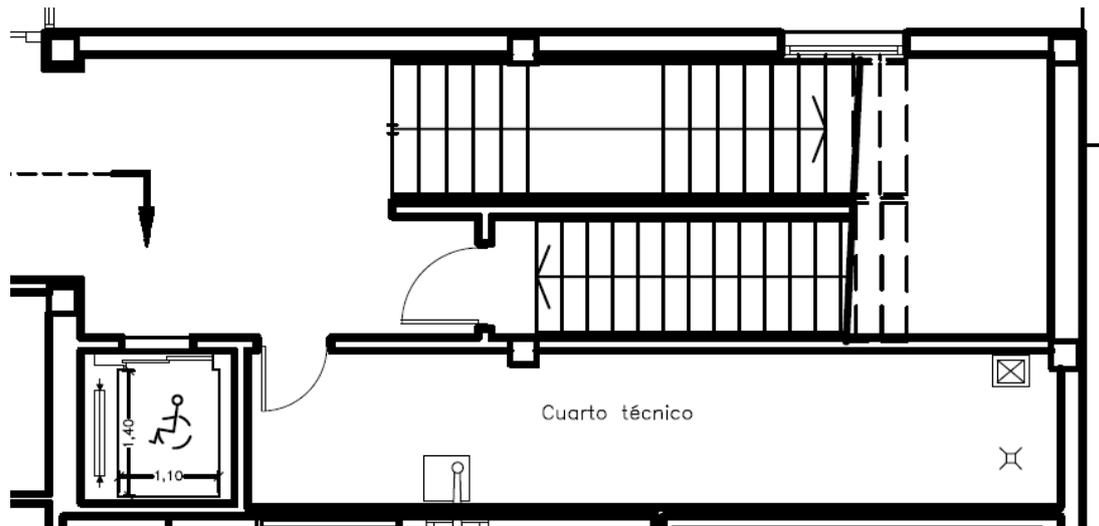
Planta Baja – Accesibilidad y Recorridos. Análisis Circulación Vertical.
